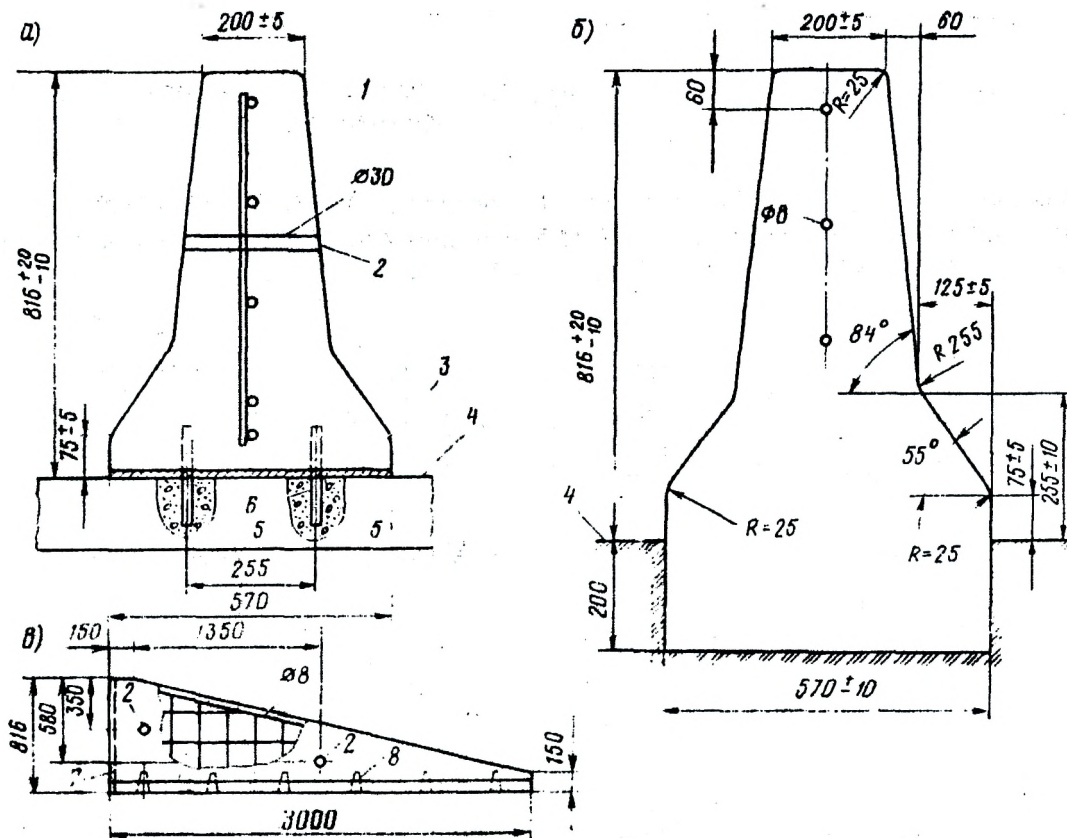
Железобетонные ограждения парапетного типа: а – сборное; б – монолитное; в – концевой блок; 1 – арматурная сетка (диаметр стержней 8 мм); 2 – отверстие для пропускания монтажных тросов; 3 – цементный раствор толщиной 10 мм; 4 – уровень дорожного покрытия; 5 – заполнение отверстий песчаным бетоном или цементным раствором; 6 – стальной штырь размером 25x200 мм; 7 – паз для соединения блоков; 8 – углубление в блоке для размещения штырей
